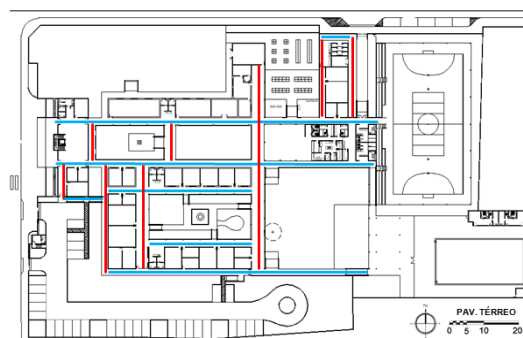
Planta baixa (sem escala) com circulações (BARROS, 2018)
